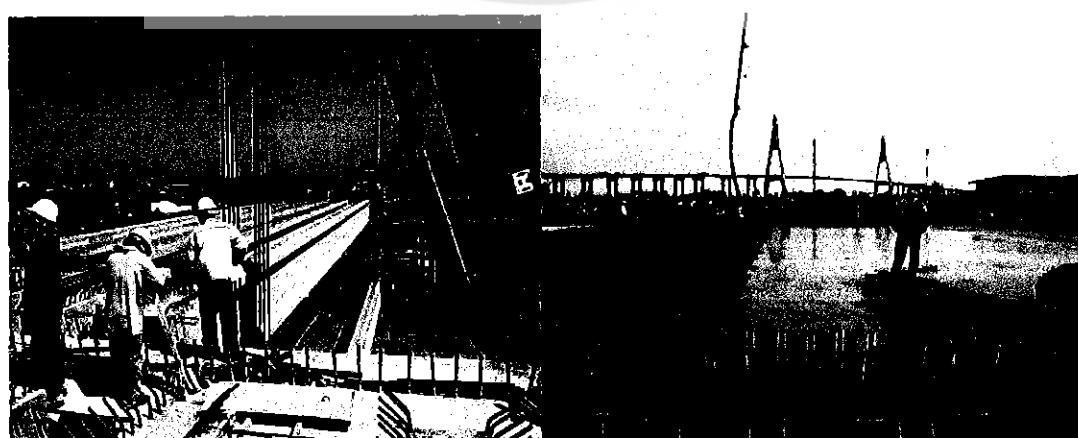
คานตามยารูปตัวที (T-Girders) และ เสารูปตัววาย (Y-shape columns)
